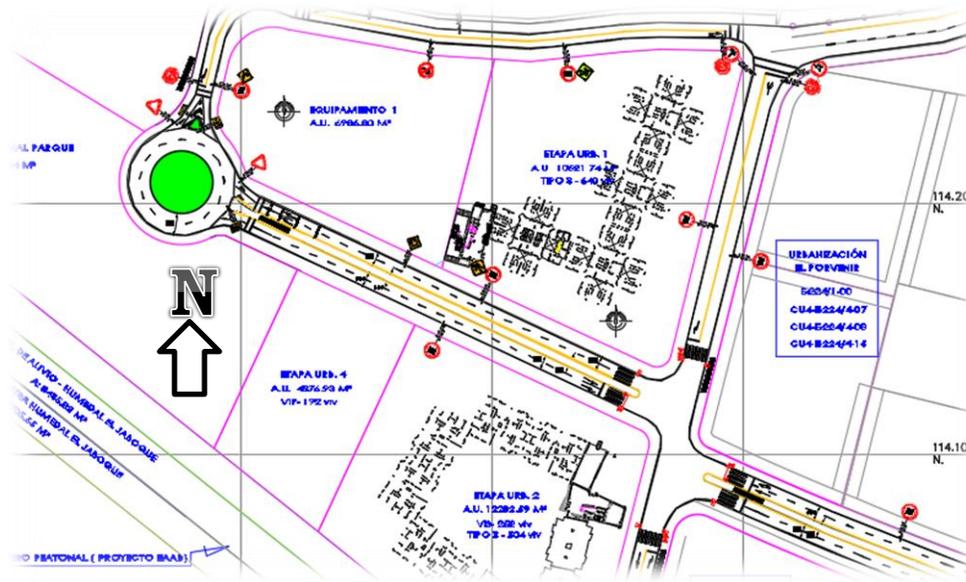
Propuesta Urbanística planteada para el Plan Parcial El Provenir.
